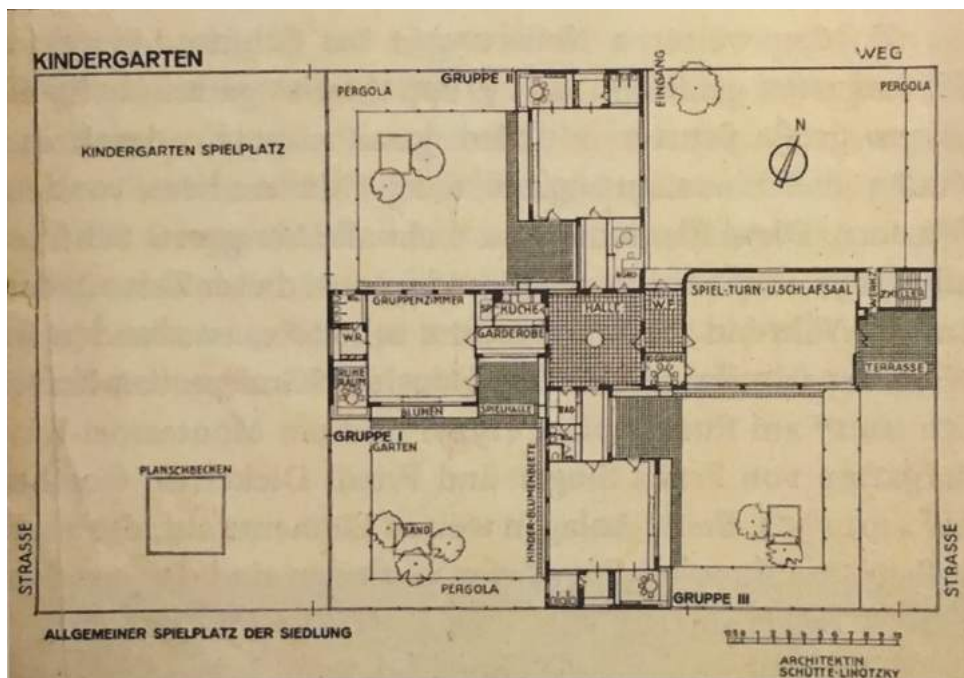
Margarete Schütte-Lihotzky, Grundriss des Kindergartens Frankfurt-Praunheim, 1929
